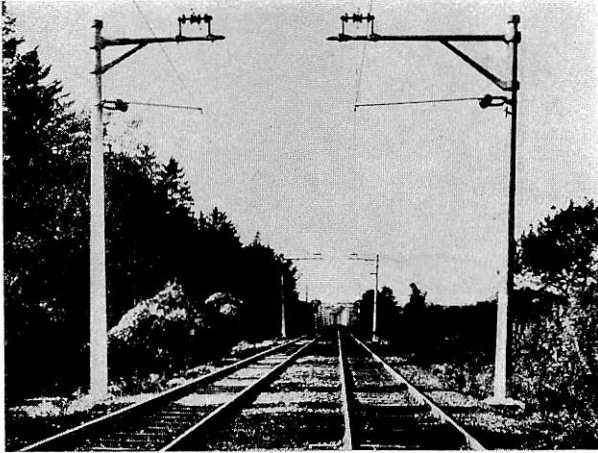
Betongstolpar med utliggare av betong. Tyska riksbanan i Bayern.
